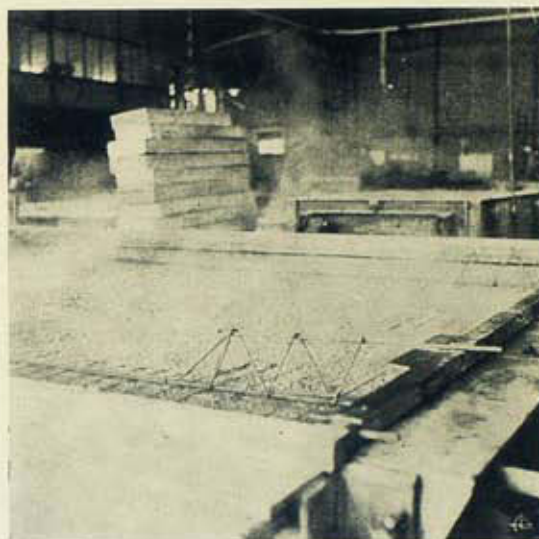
Fabrico de um elemento vazado para pavimentos (moldes metálicos — armaduras da laje apoiando em vigotas a fundir conjuntamente — 1.^a betonagem — ao fundo cofragem de madeira para utilização conforme fig. 3).
